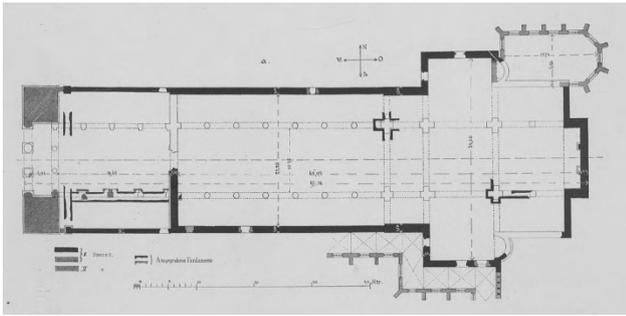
Grundriss nach E. Paulus 1893
